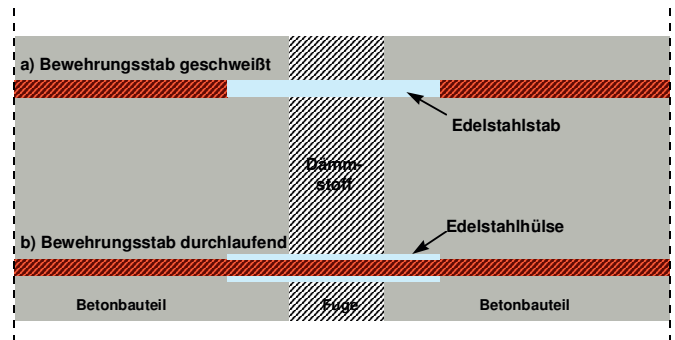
Bewehrungsstab a) mit eingeschweißtem Edelstahlstab und b) durchlaufend mit Edelstahlmantel
